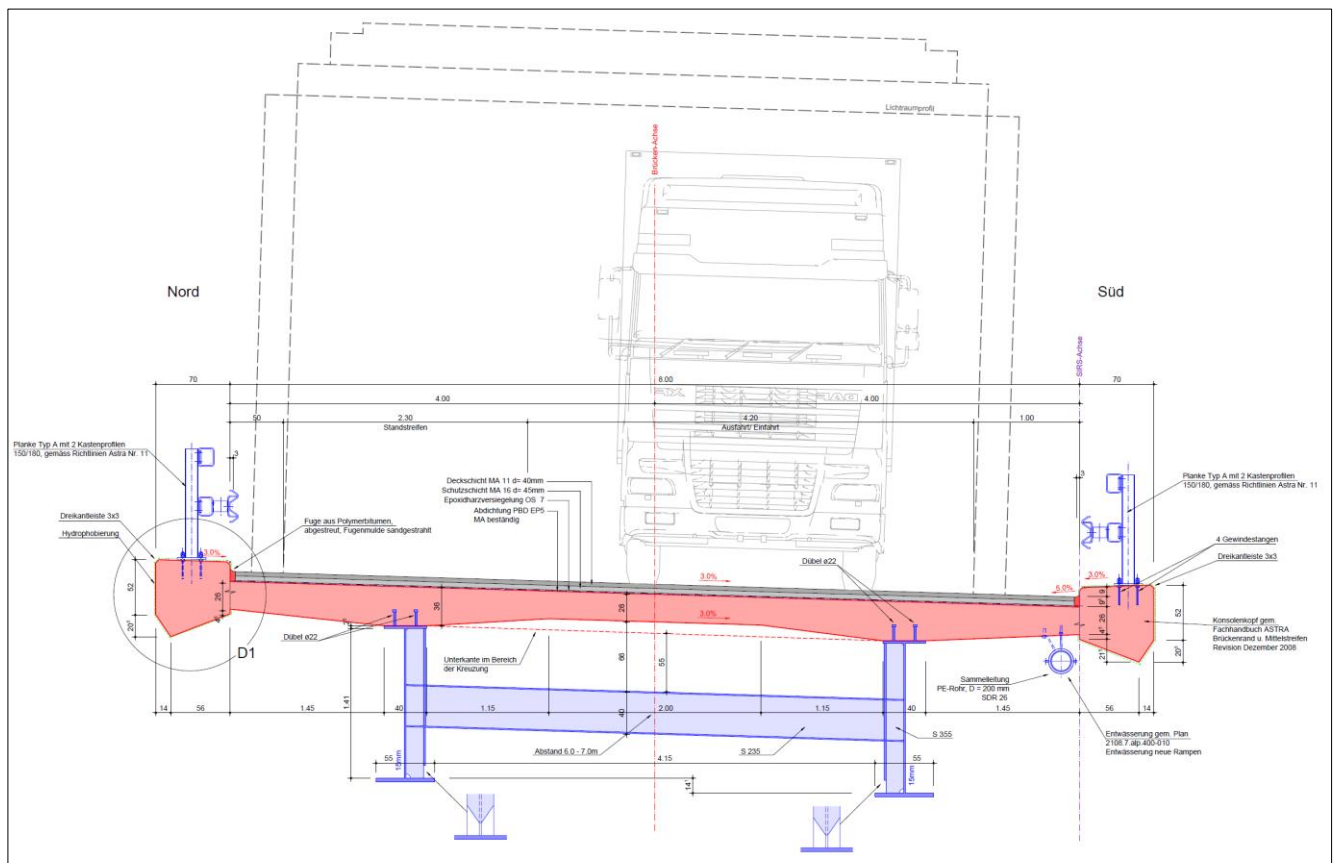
Brückenquerschnitt im Feld mit Querträger
